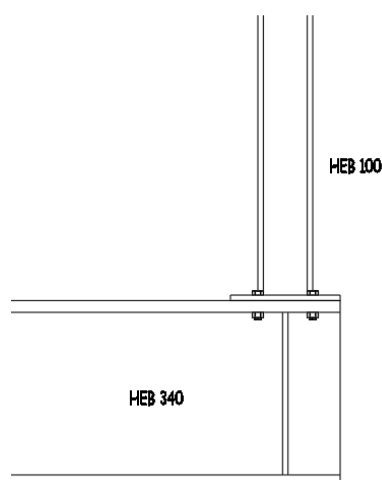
Ligação do tirante com a viga V1 do piso 1
